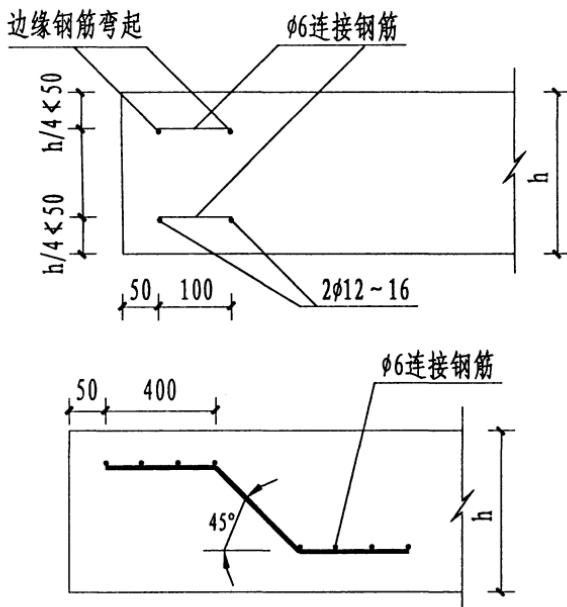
边缘钢筋布置(尺寸单位:mm)
